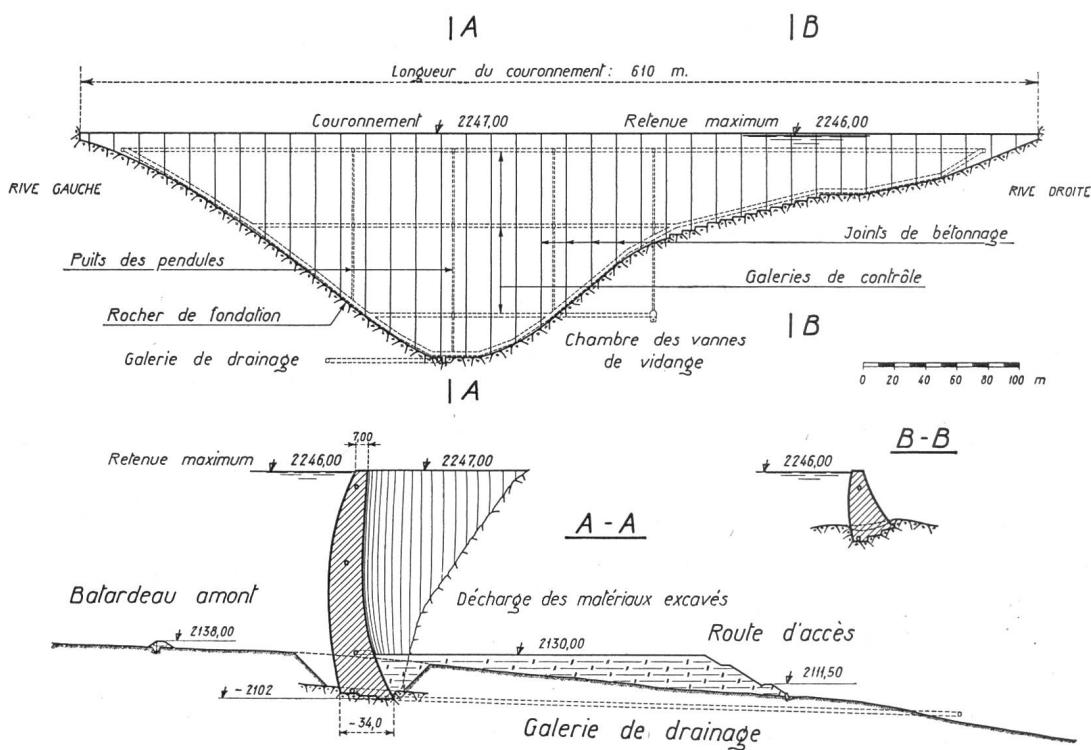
Barrage de Moiry. Élévation développée du parement amont et coupes verticales
